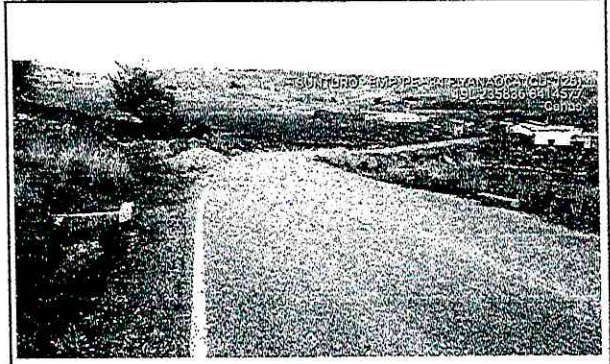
ALCANTARILLA DE CONCRETO 109+500
